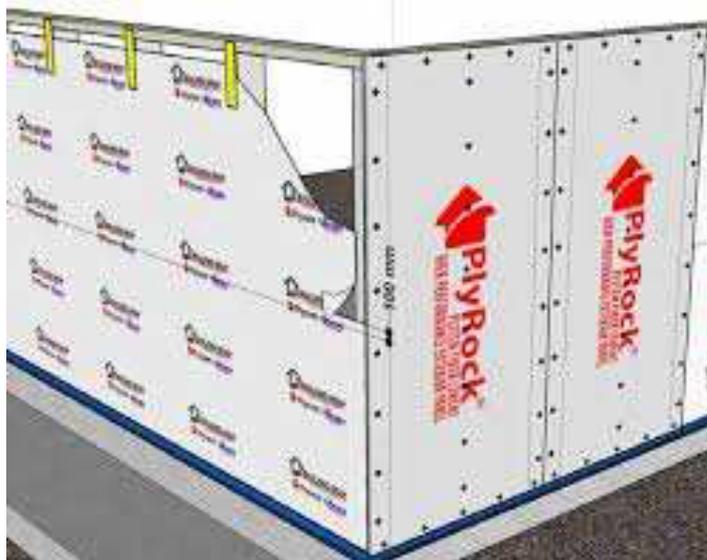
Sistema constructivo Plycem, fuente: Cartilla de la construcción 2017
